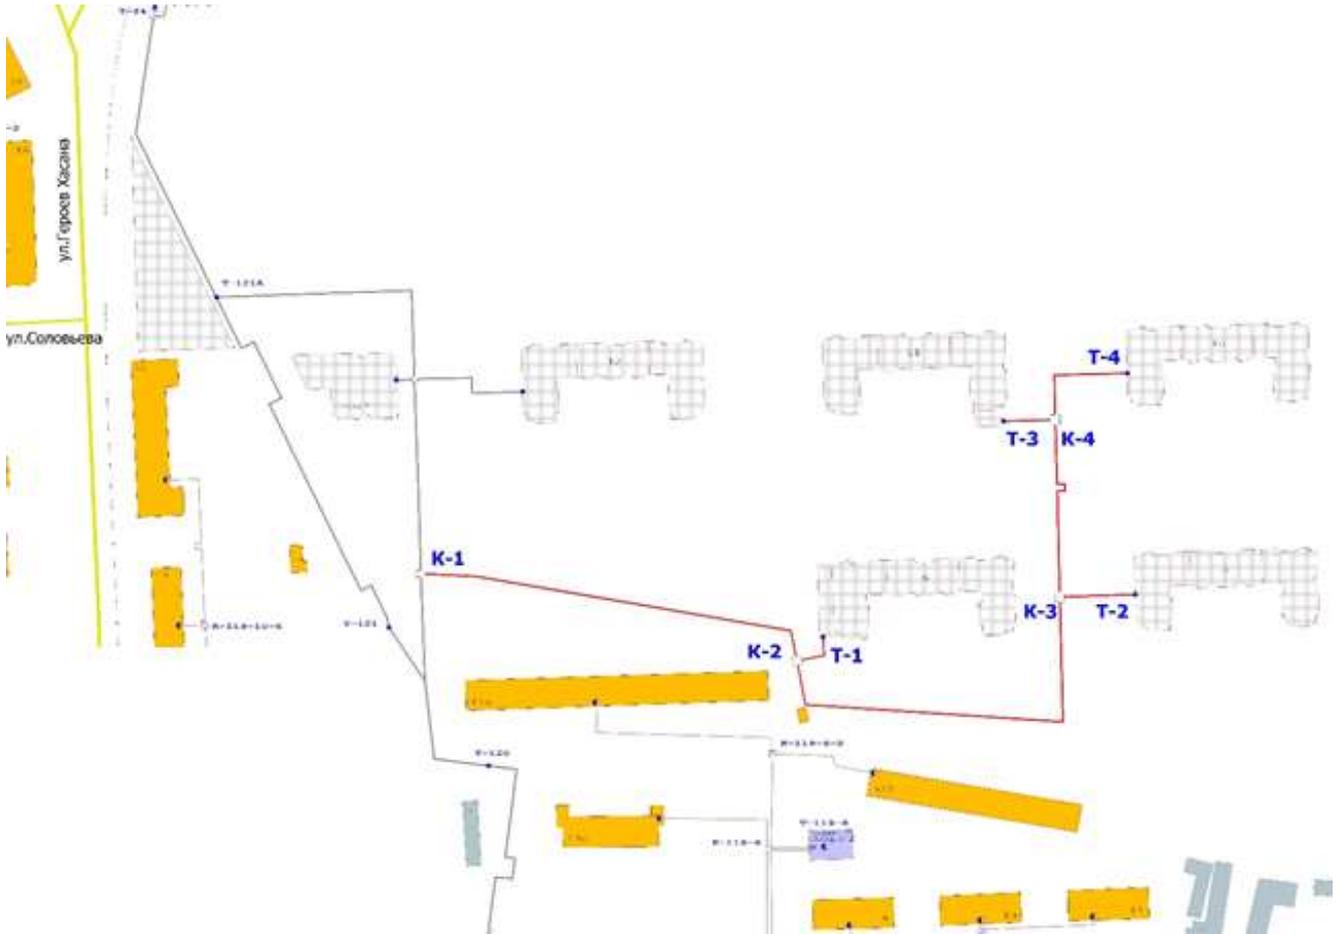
Ситуационный план развития системы теплоснабжения «Комплекса многоквартирных жилых домов по ул. Красные казармы, кв.272.»
